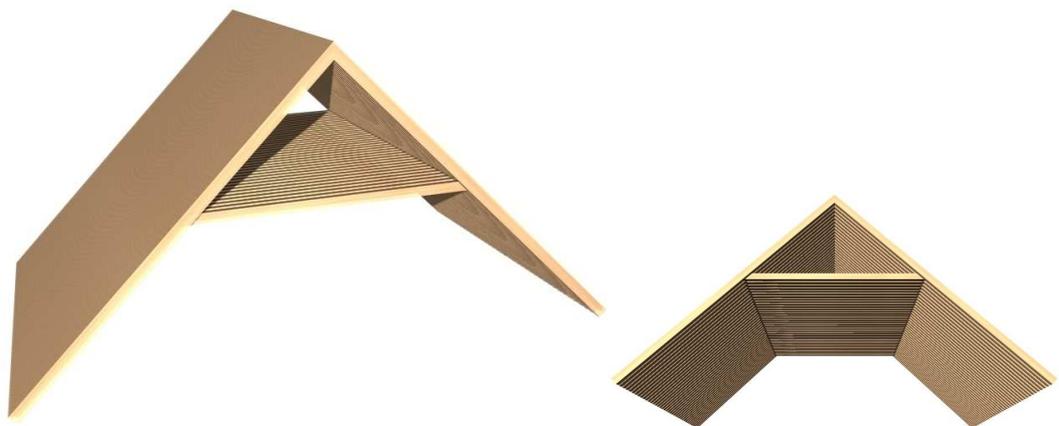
Toiture VégA : Principe d'un panneau auto-portant, avec blocage (encastrement) du faîte par un tirant retroussé, développé en plaque sur toute la longueur.
